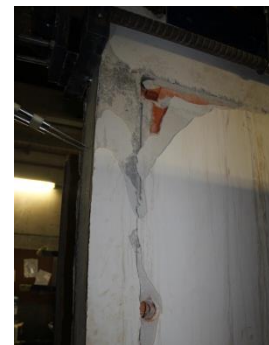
Padrão de fendilhação do pano exterior do painel Wall_DPA_01.
